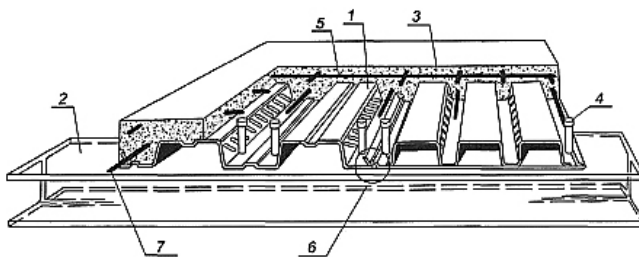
Конструкция монолитного перекрытия по СПН с вертикальными стержневыми анкерами
